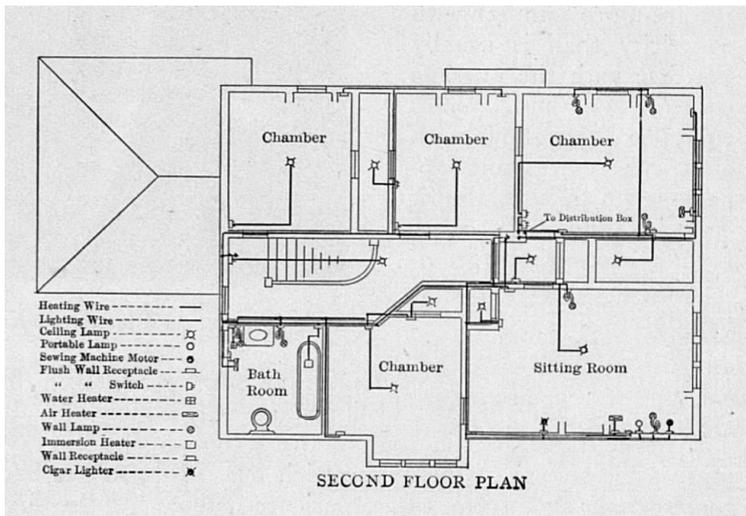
Grundriss von Hillmans Haus (Stannard 1906, 322)
